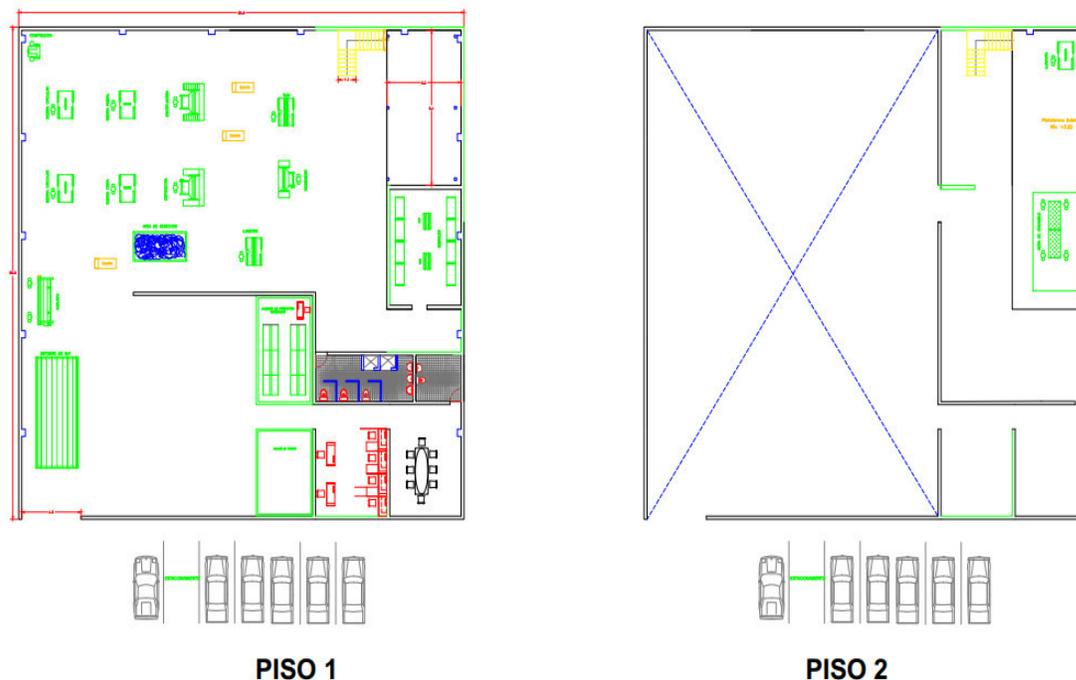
Vista de planta. Fuente: Elaborado por el autor.
